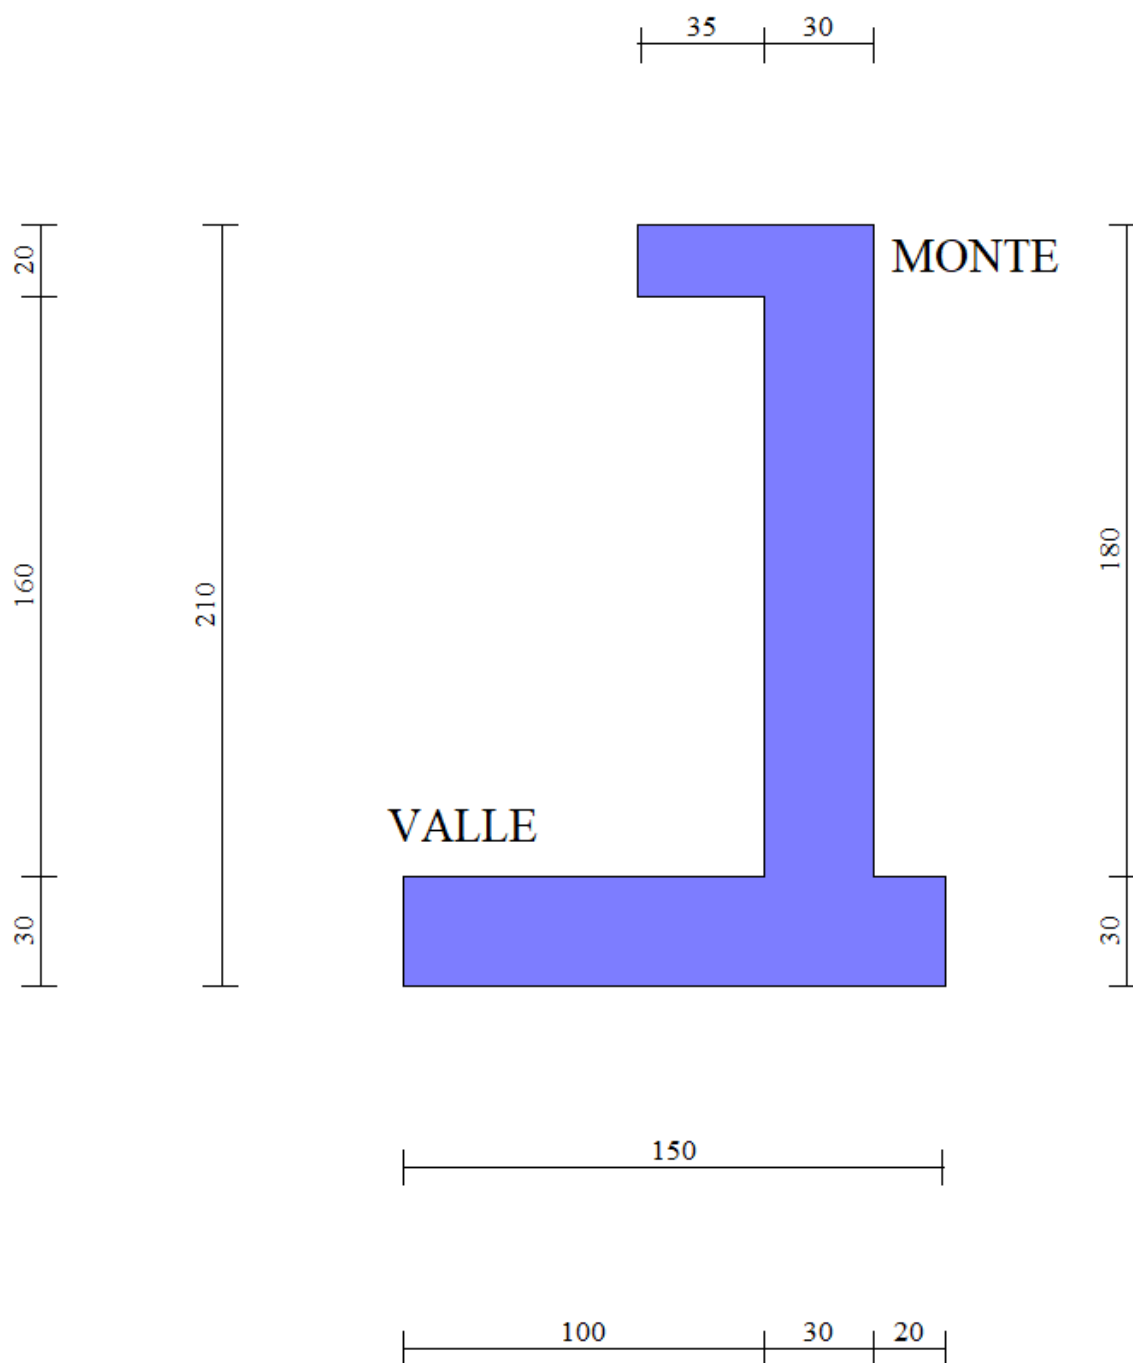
Estratto dal software di calcolo MAX 16.0 – Geometria di modellazione in sezione
